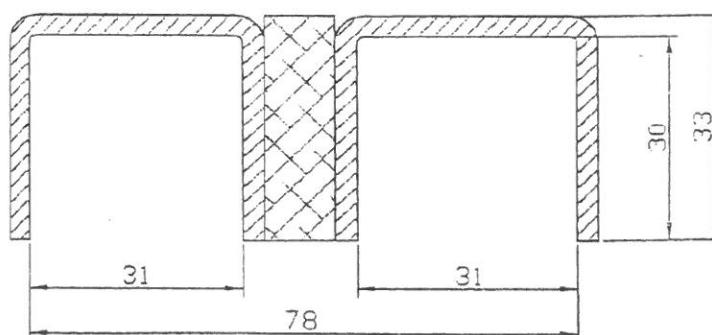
Brama przesuwna N80 – przekrój poziomy przez pionową krawędź labiryntową skrzydła
